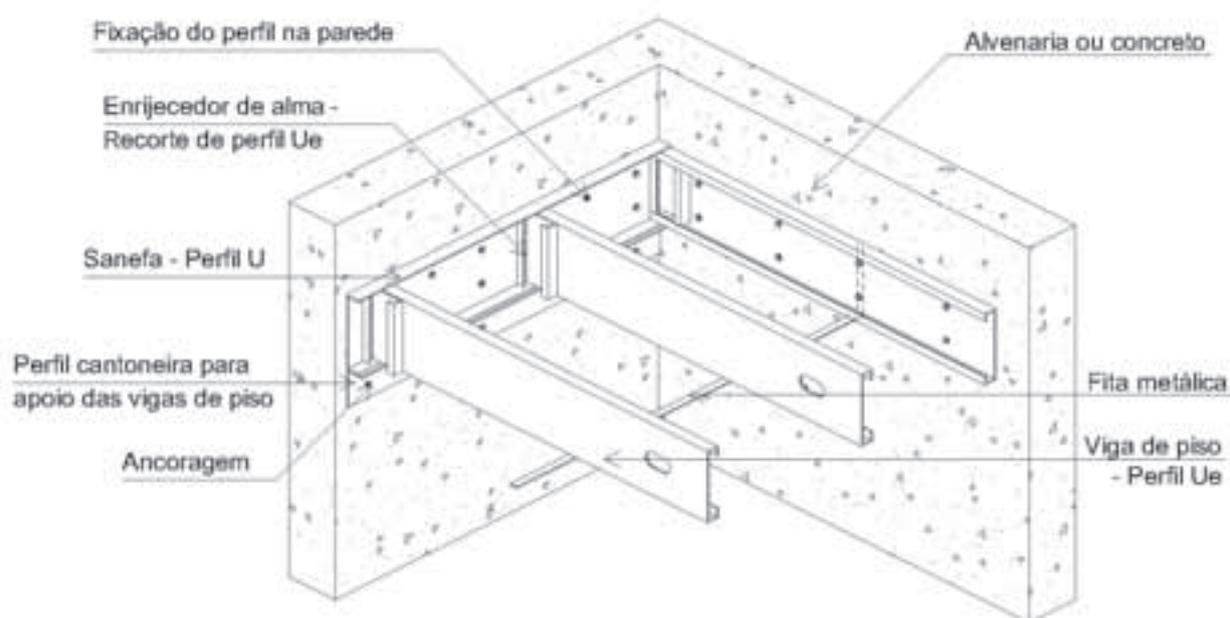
Laje em Light Steel Framing apoiada sobre estrutura tradicional
